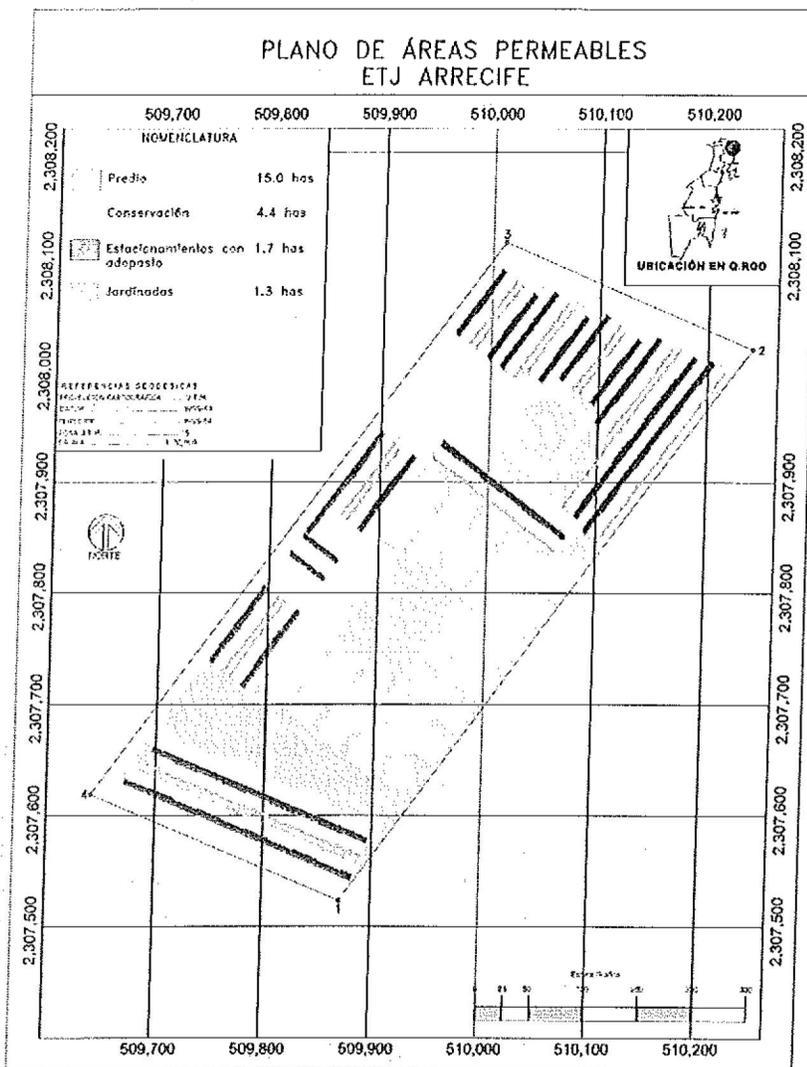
Plano de áreas permeables en donde se podrá realizar la reforestación.
